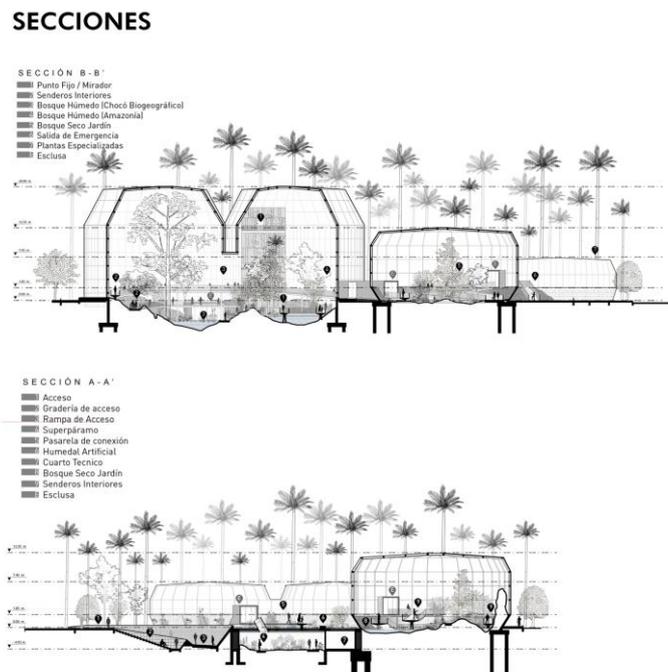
Diagrama “secciones”. Extraído de: arquitecturapanamericana.com
